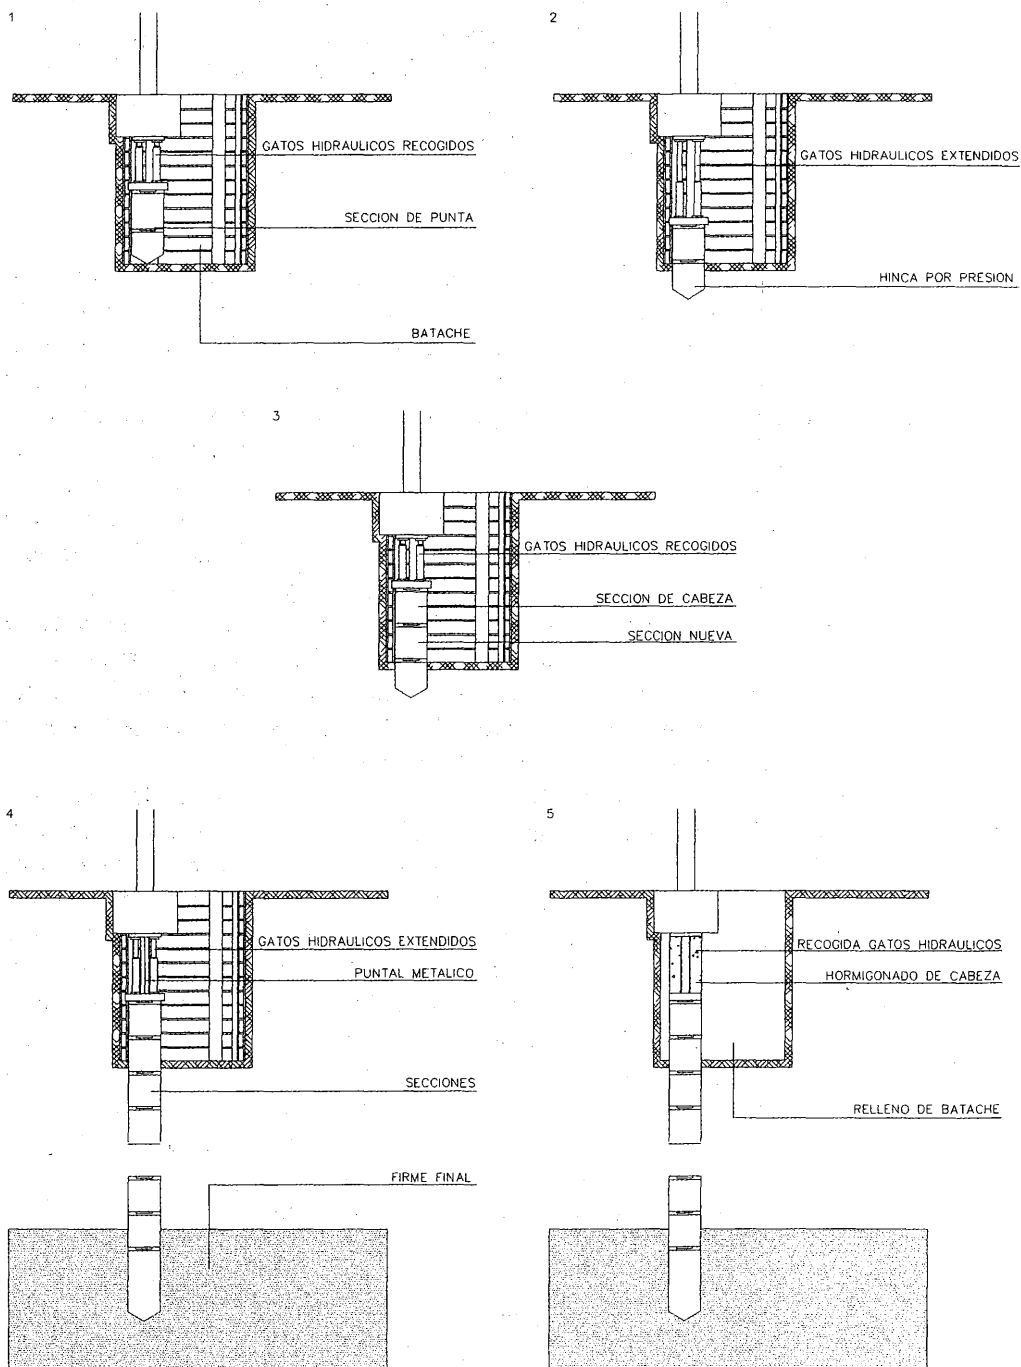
Pilotes hincados tipo PRETEST a presión.
